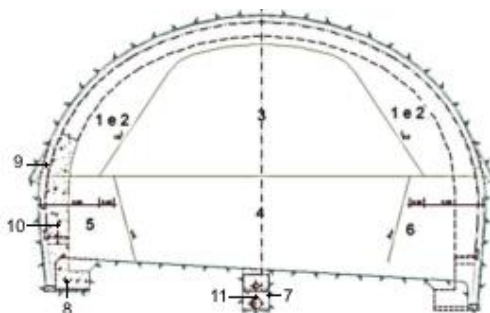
Seção de alargamento - ZG3 (HEB180)
